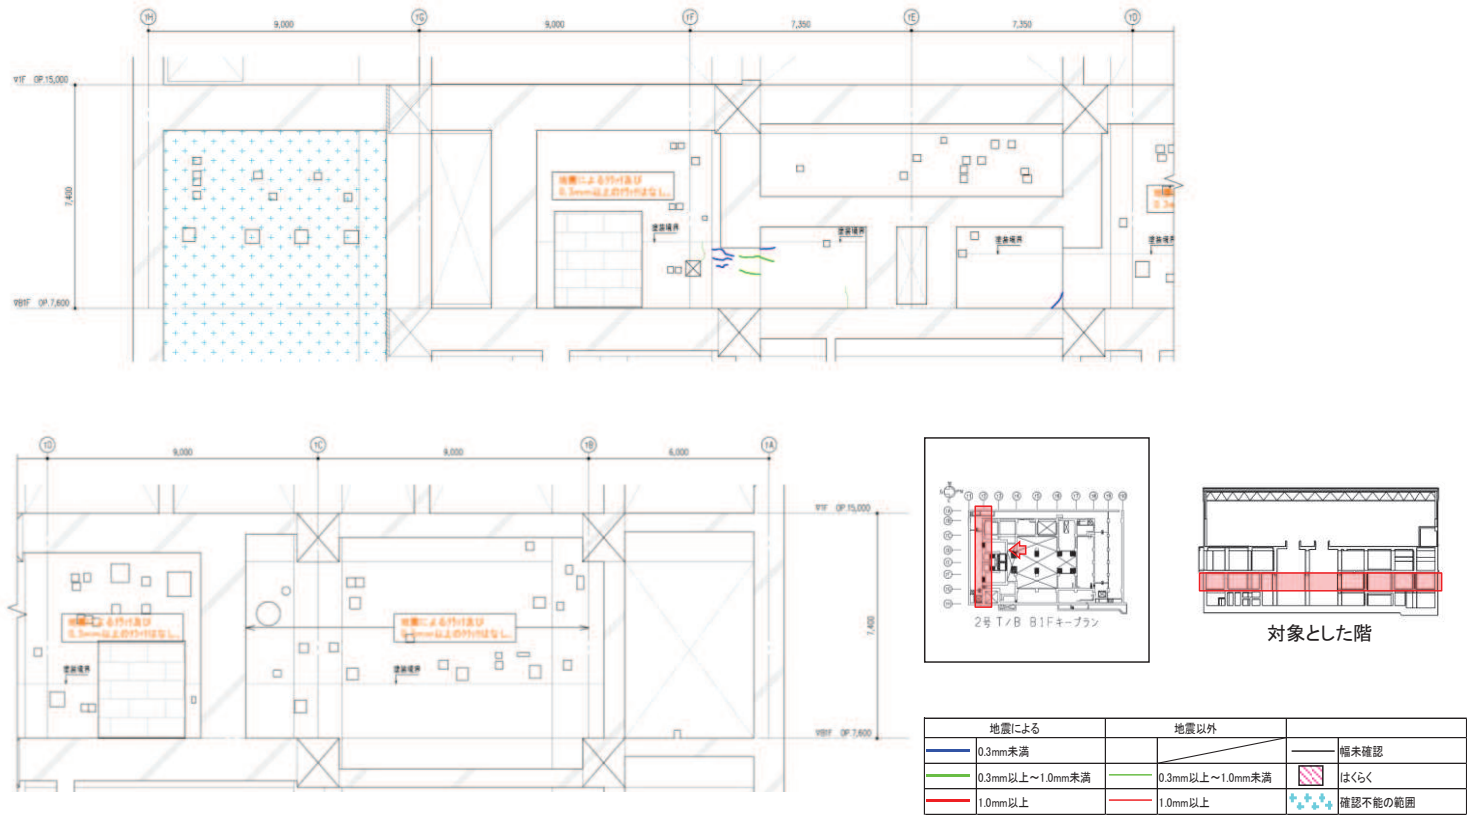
タービン建屋のひび割れ分布 耐震壁 (18) 地下 1 階 T2 通り
